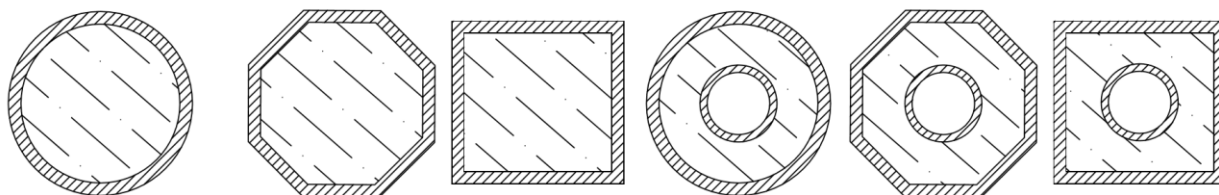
Виды поперечных сечений трубобетонных элементов (составлено авторами)
